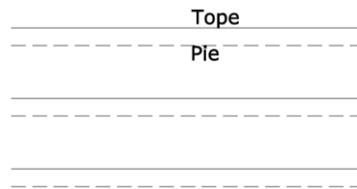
Vista en planta del talud (Fuente: Propia)
